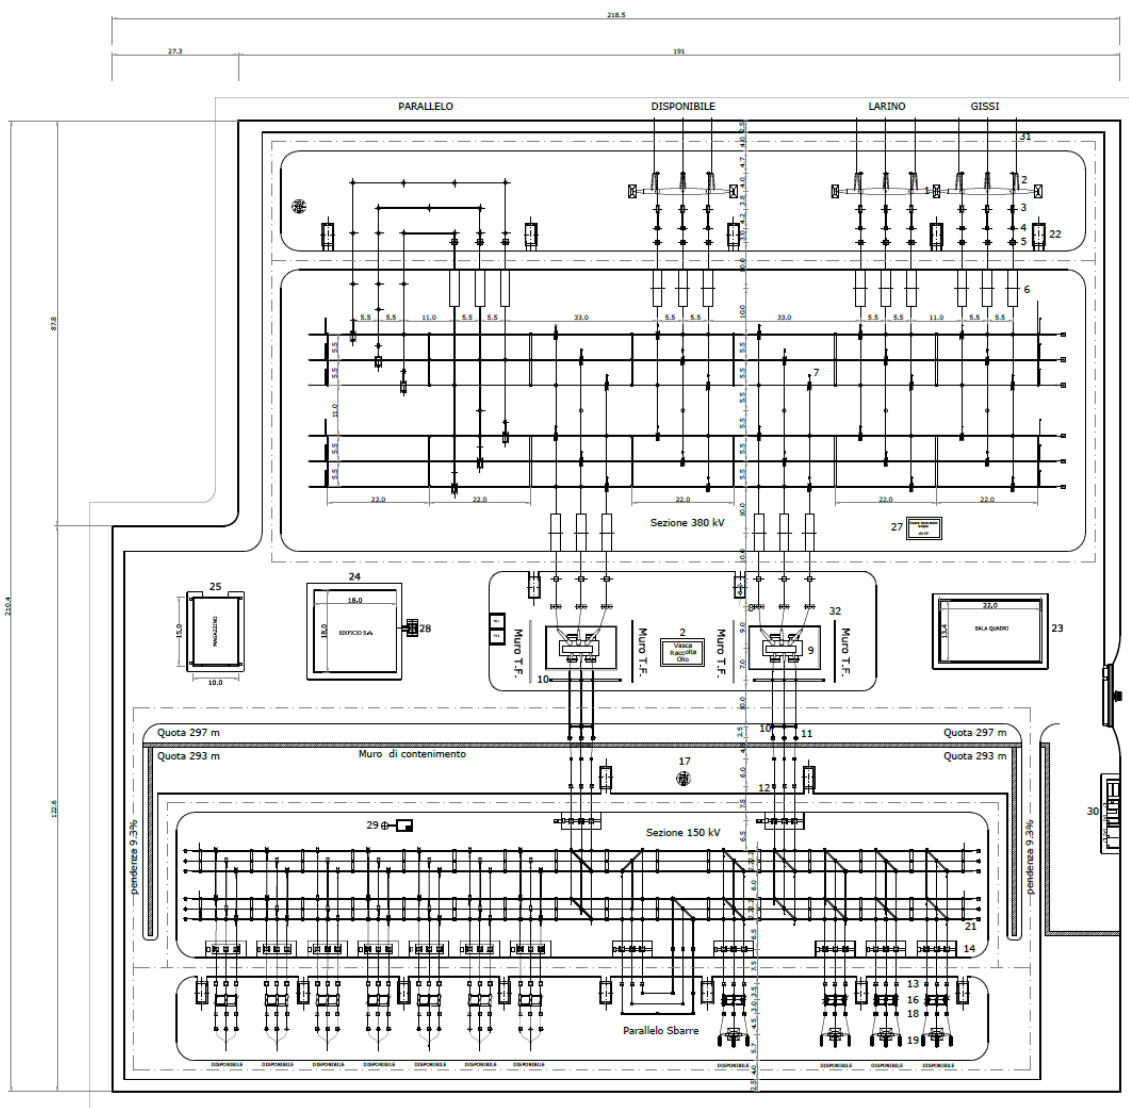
Planimetria generale di impianto della nuova stazione RTN.
